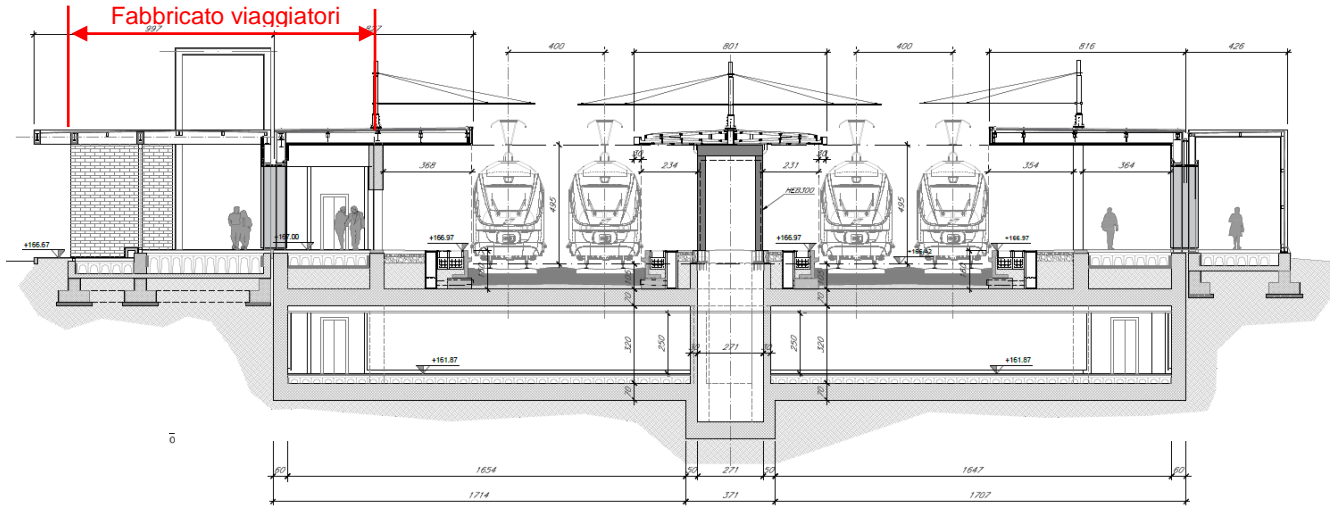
Sezione tipo stazione di Anguillara in corrispondenza del sottopasso di stazione
